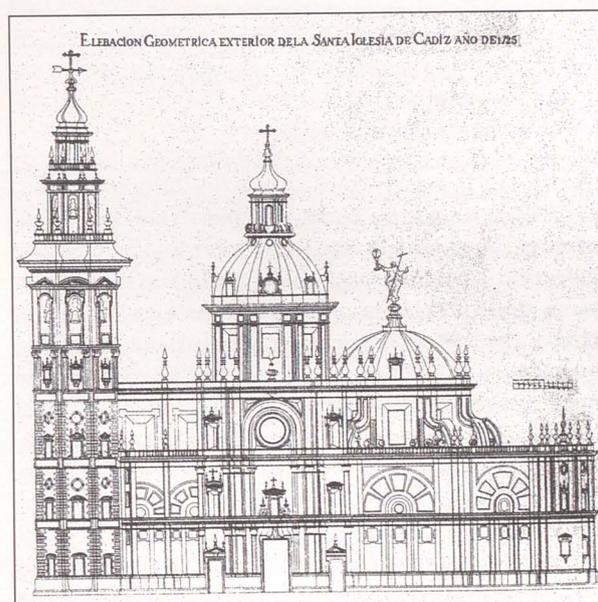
Catedral de Cádiz. Alzado longitudinal de 1725 sobre el calco de Pablo Gutiérrez Moreno (1928).
